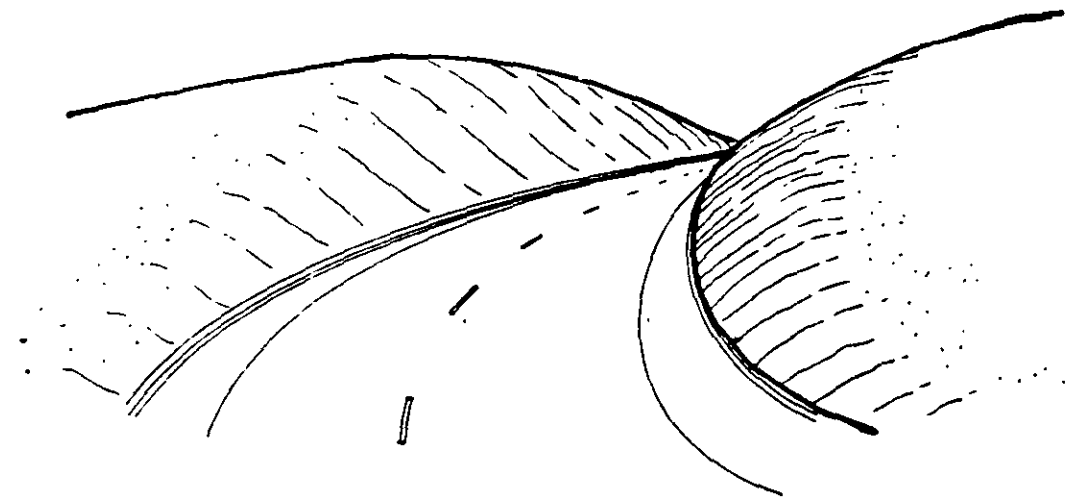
CORTE SUAVE EN CURVA HORIZONTAL
